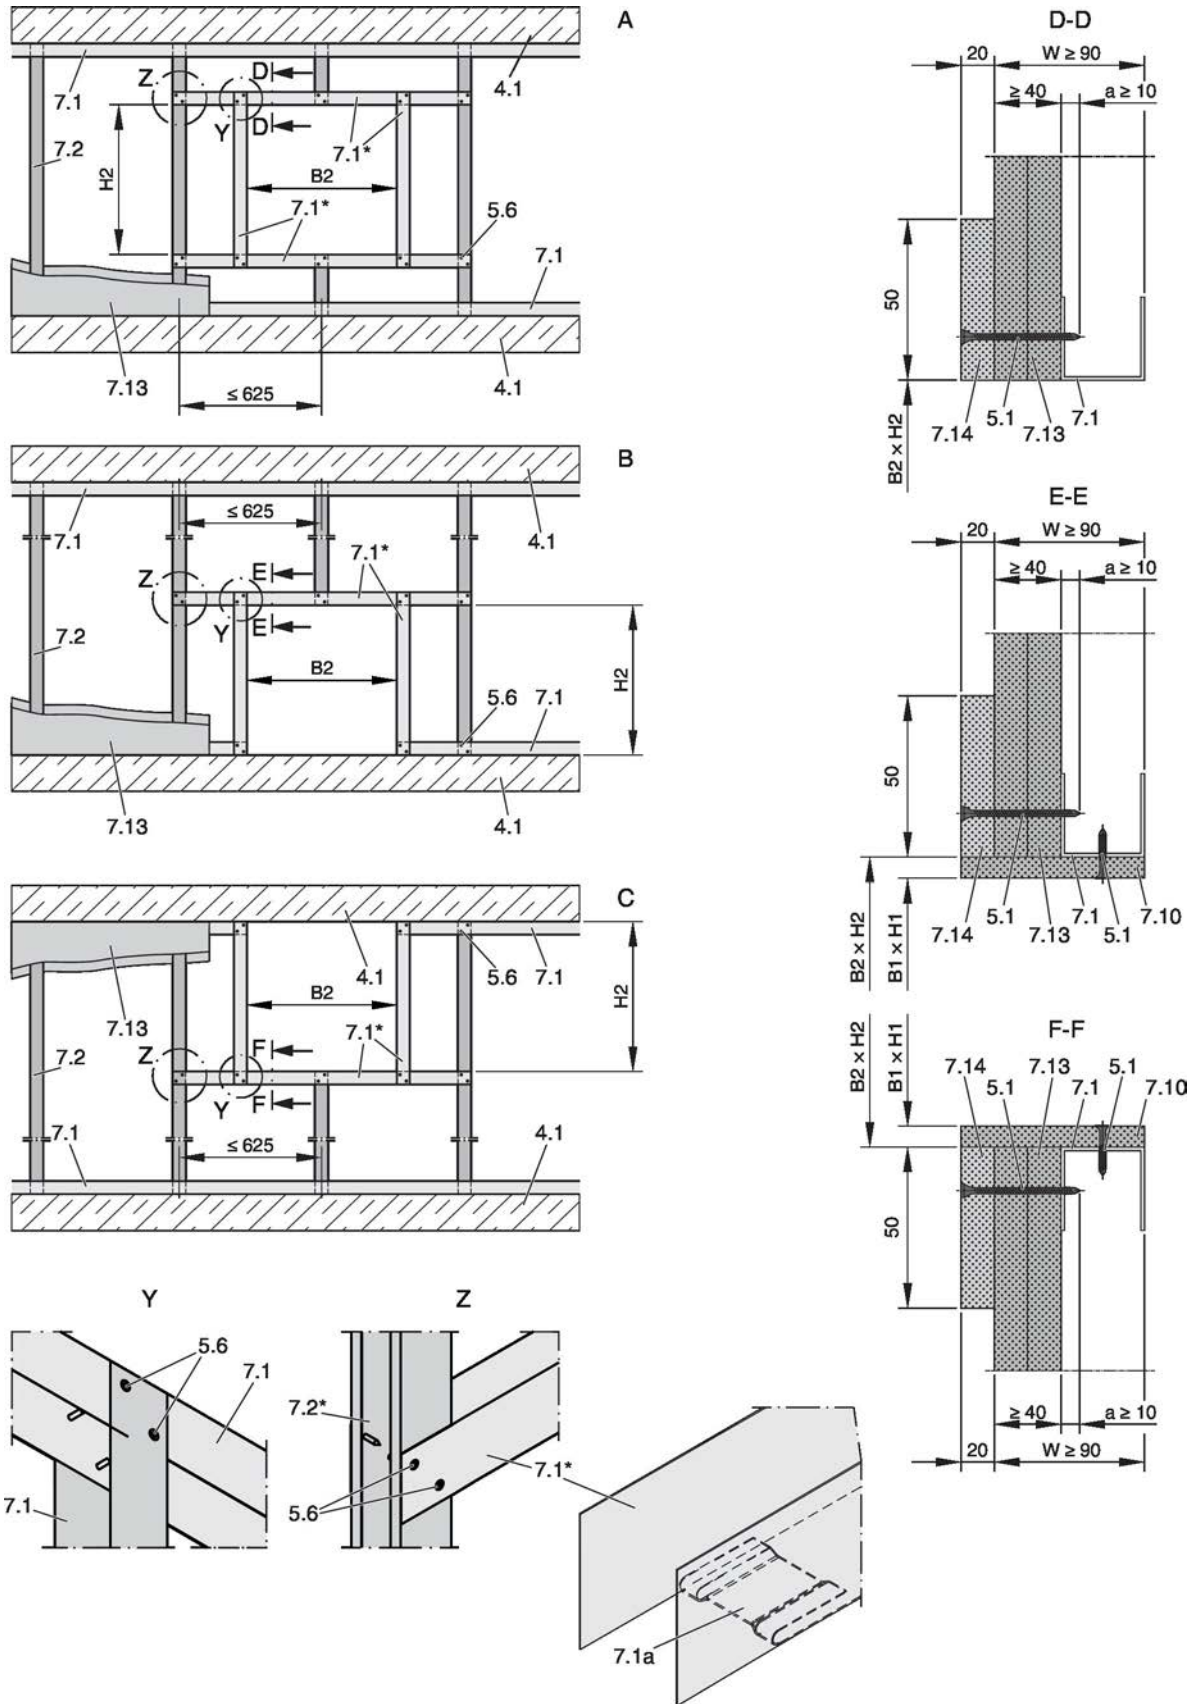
Schachtwand mit Metallständer und einseitiger Beplankung
